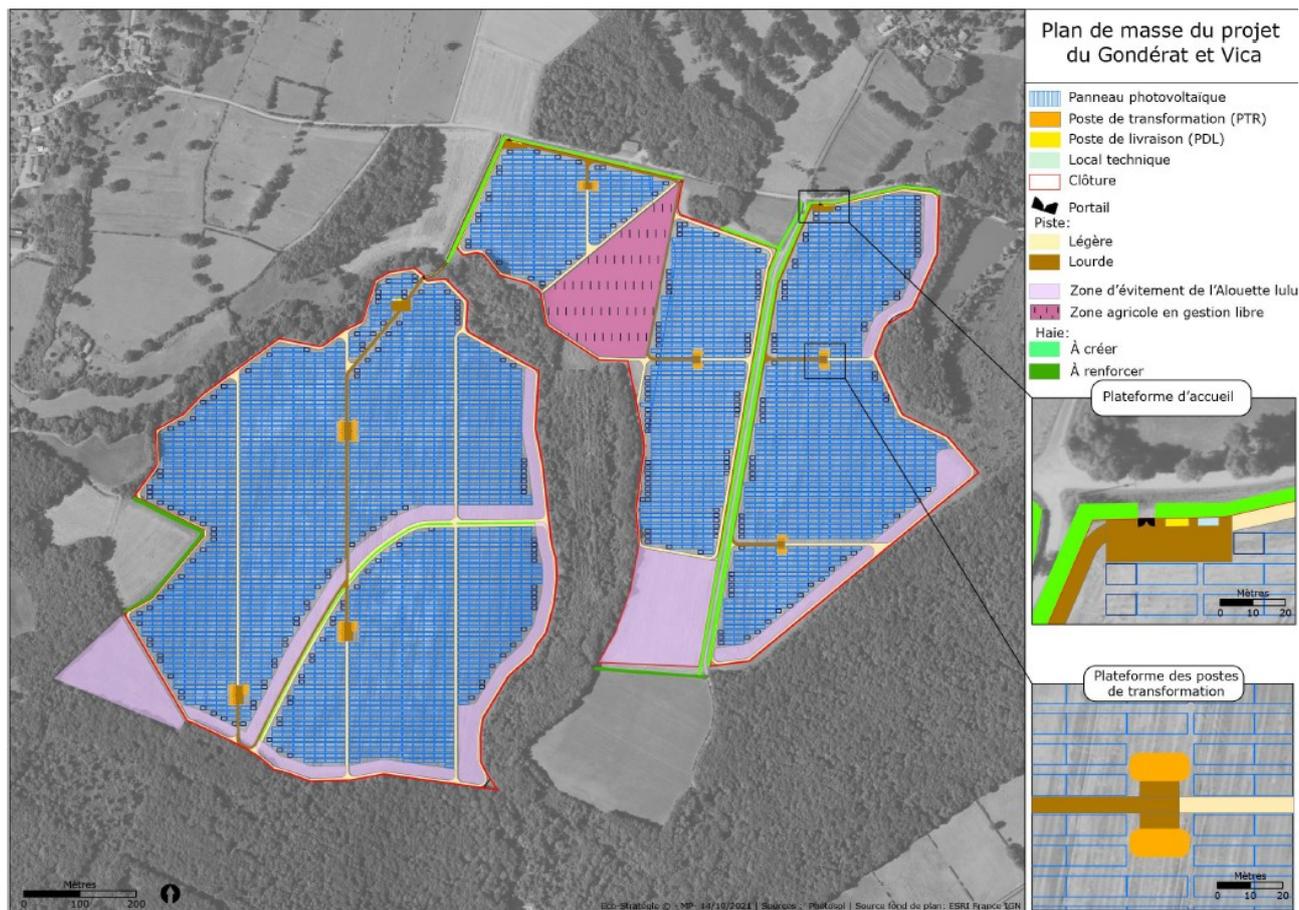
Plan masse du projet. Source : Etude d'impact, page 18.
